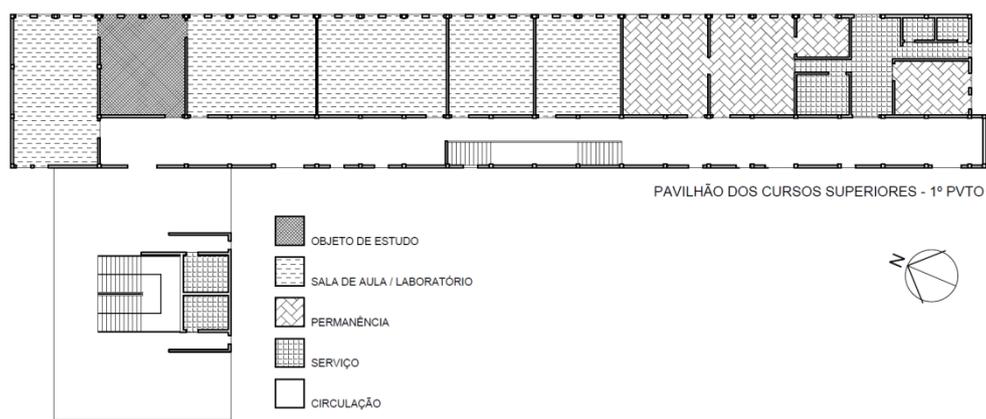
Planta baixa esquemática do pavilhão dos cursos superiores.
